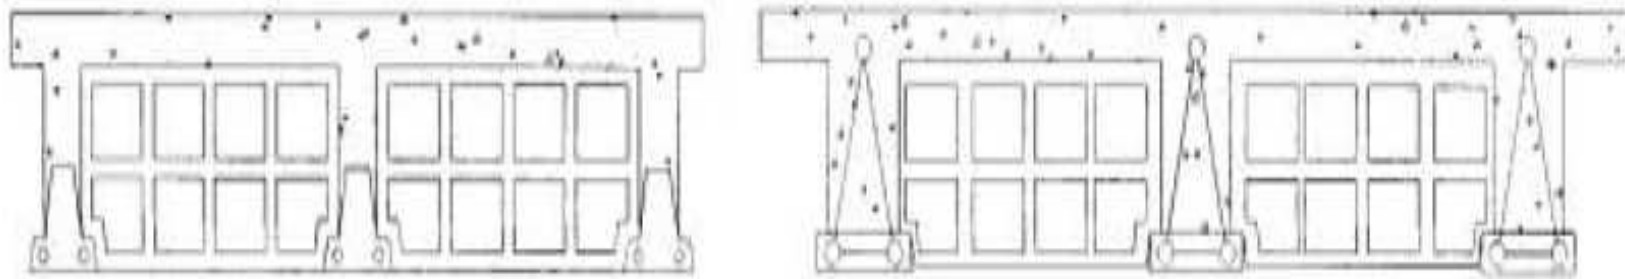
Lajes com vigotas pré-moldadas (PEREIRA, 2001)
